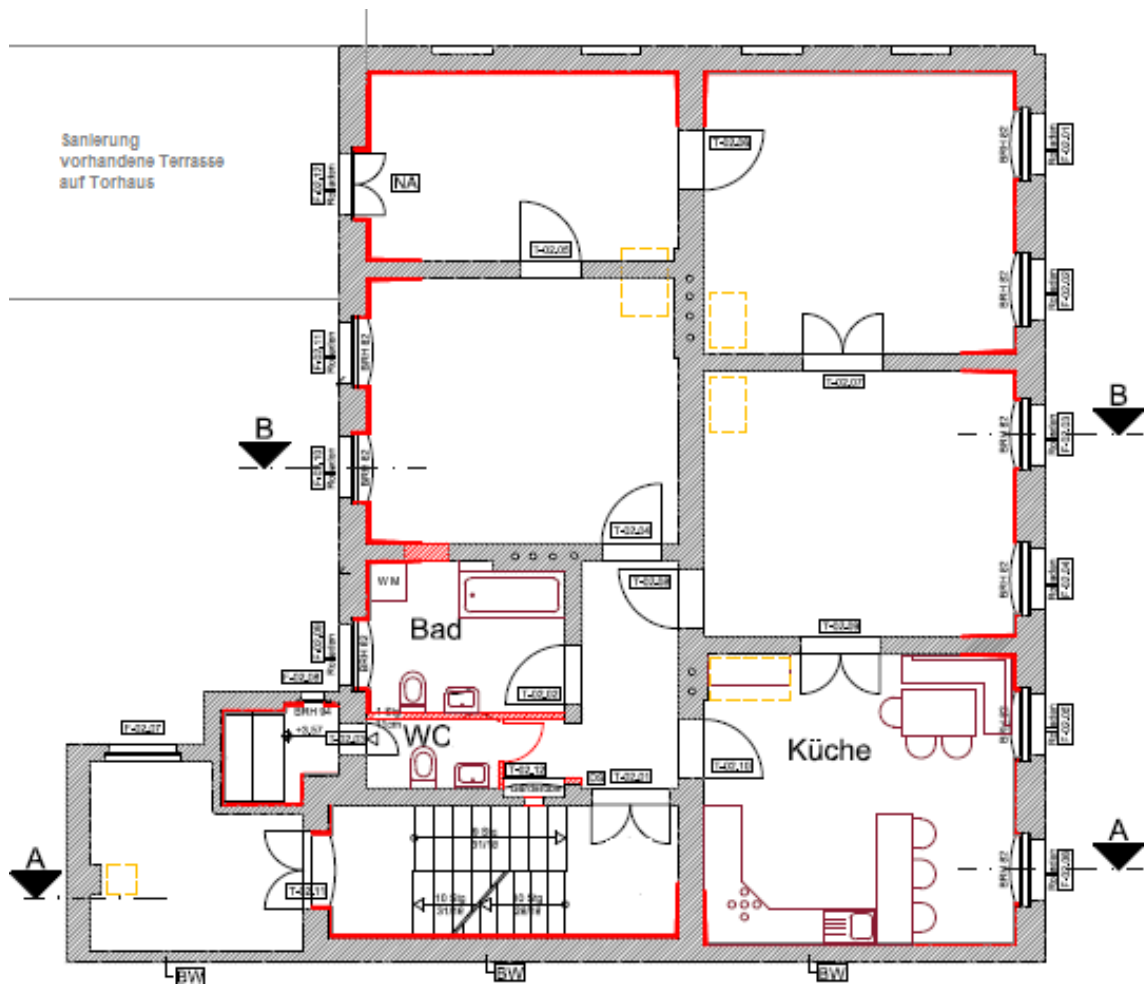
Grundriss Sanierung Obergeschoss<sup>171</sup>
